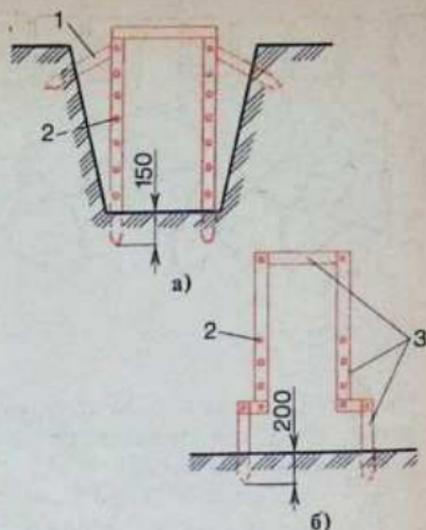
Шаблоны для кладки бутовых ленточных фундаментов:
